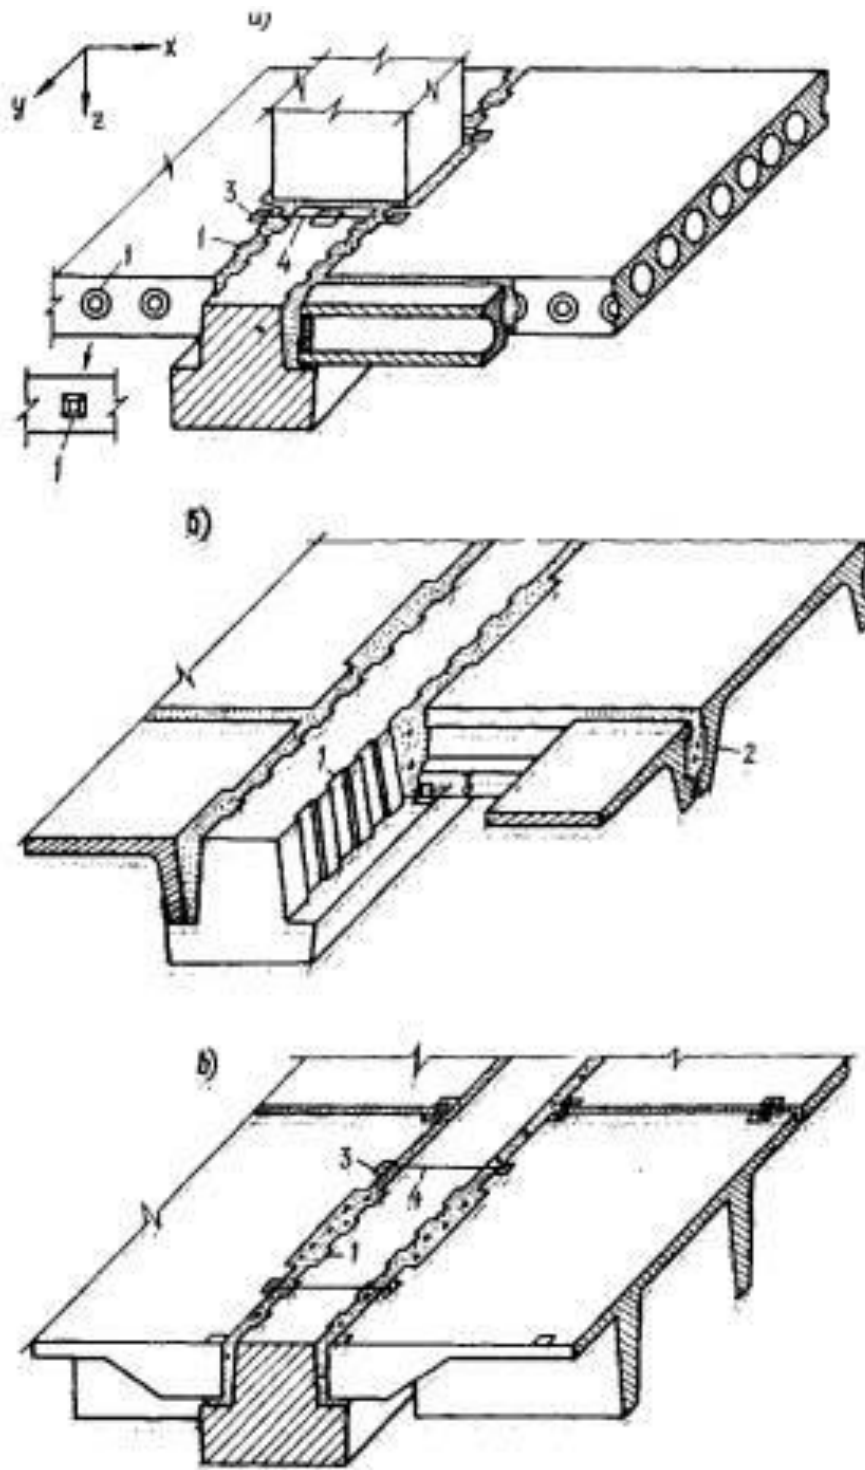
Спирання плит перекриття на ригелі в рамно-в'язевому каркасі.
